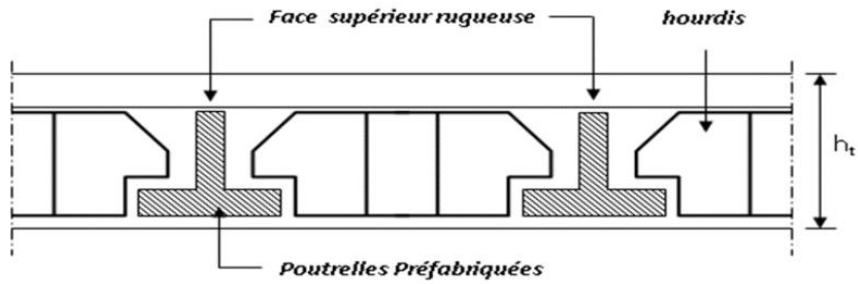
Coupe verticale du plancher à corps creux [31].
